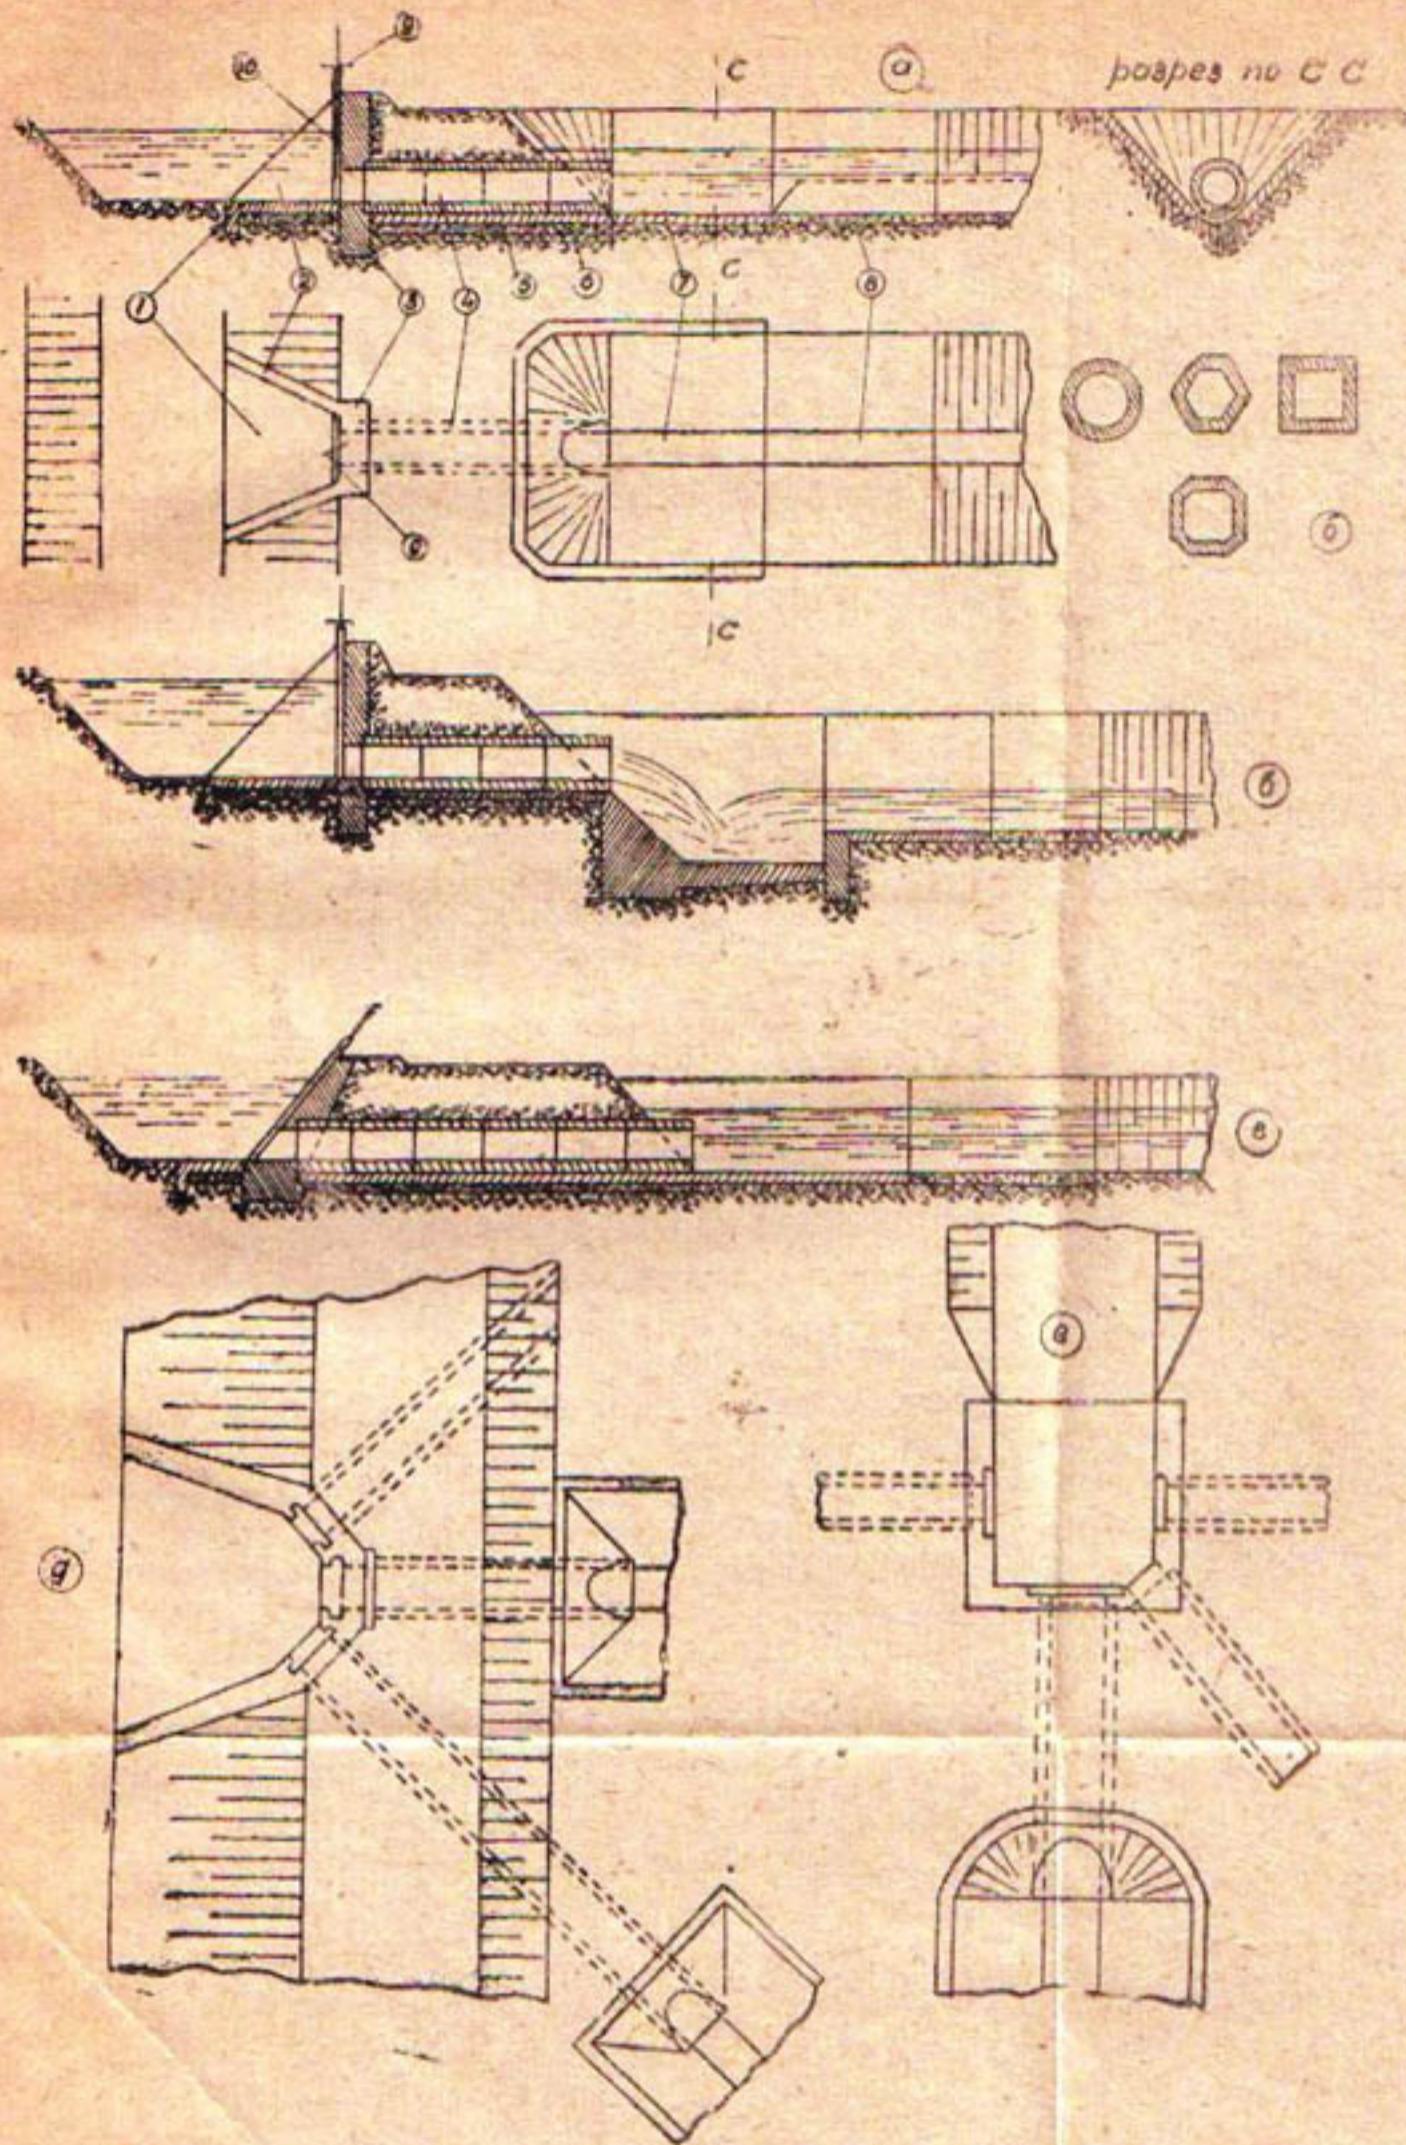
1 — Понур; 2 — крылья; 3 — подпорная стенка; 4 — труба; 5 — пли-
